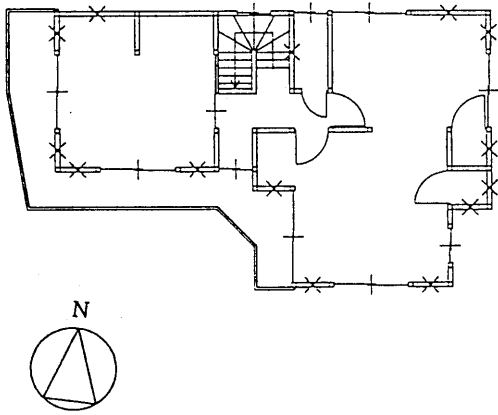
解析対象建築物平面図 (No.3, No.4)
